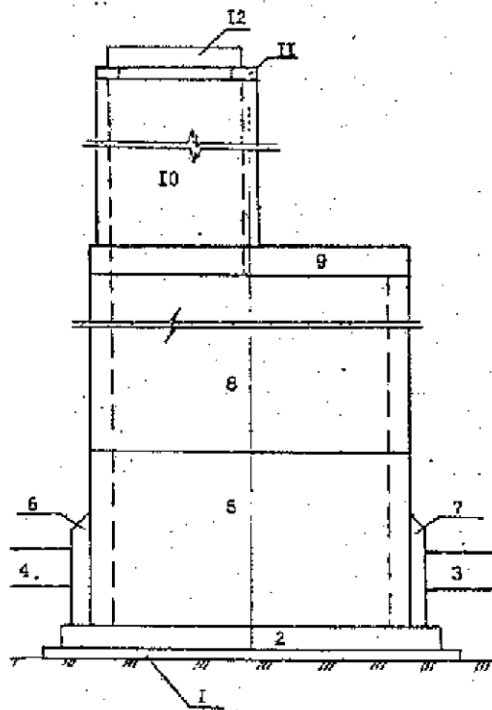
Конструкция круглого колодца из сборных железобетонных элементов.
